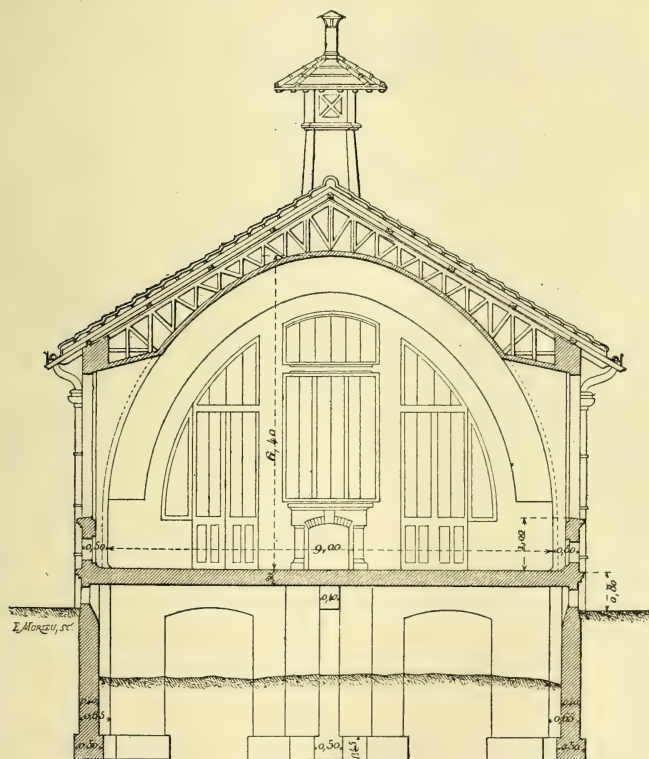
Coupe d'un pavillon de l'hôpital Boucicaut.
